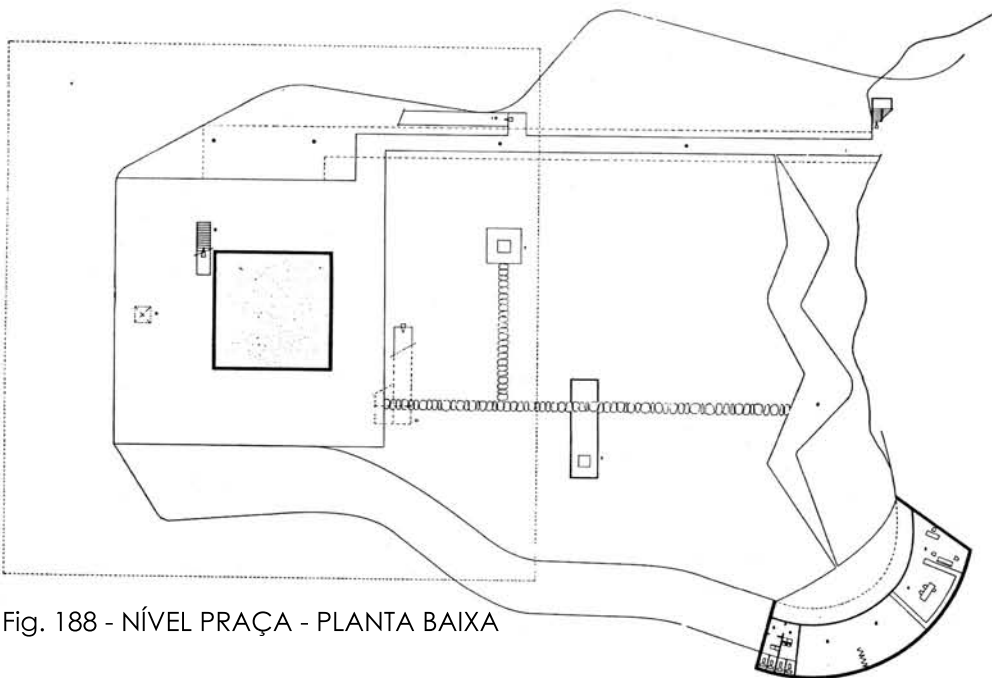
NÍVEL PRAÇA - PLANTA BAIXA
